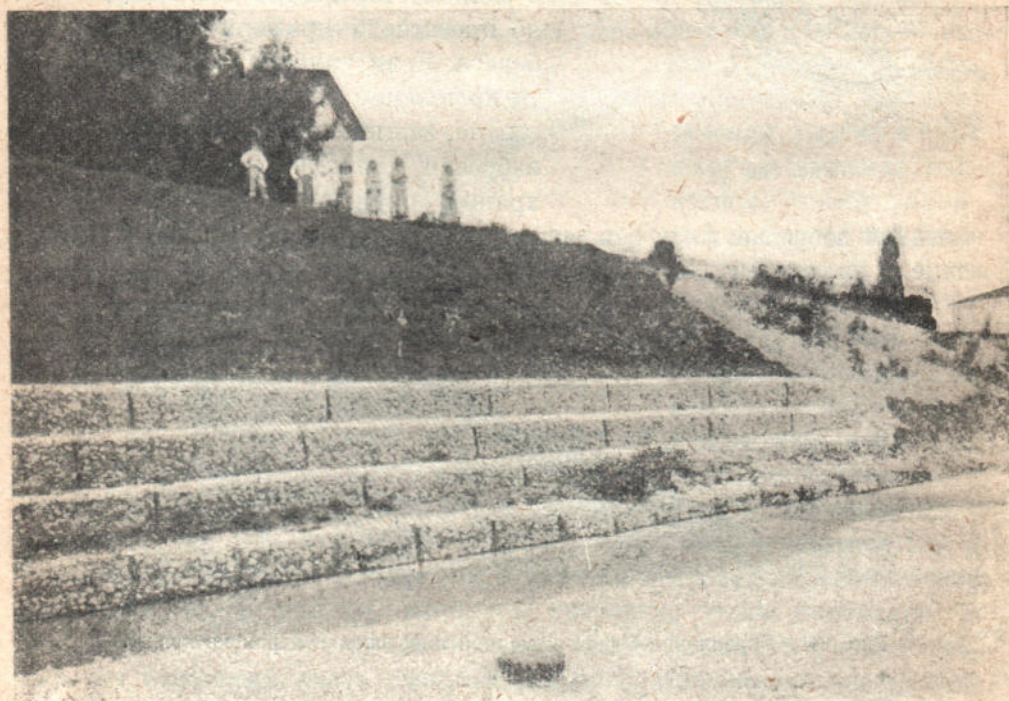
Береговое укрепление, построенное из кладки габионов.
